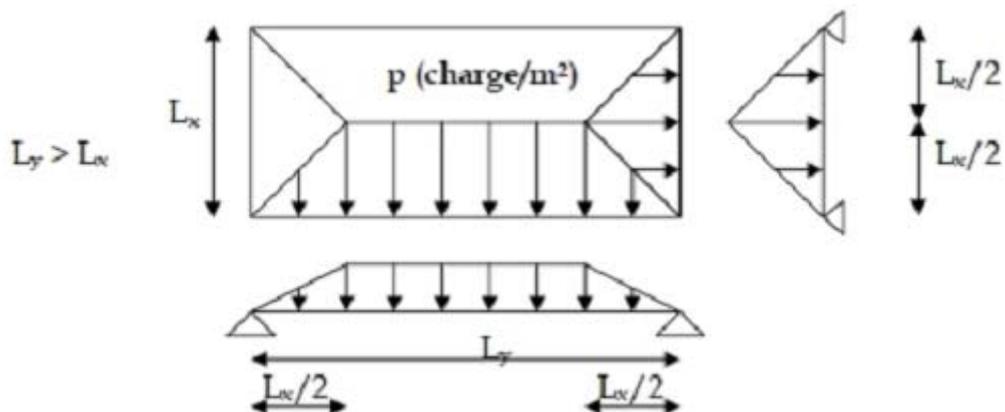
Répartition des charges verticales sur une poutre d'un plancher.
